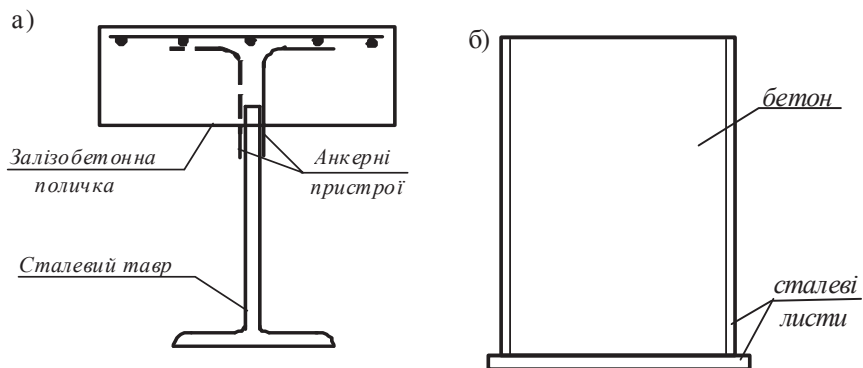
Поперечні перерізи сталезалізобетонних балок: а) двотаврові із залізобетонним верхнім поясом; б) із зовнішнім листовим армуванням
